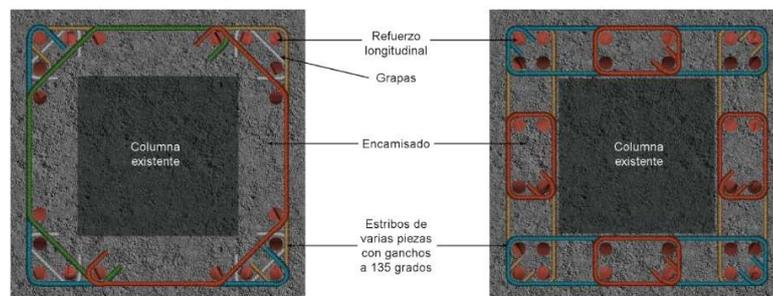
Posibles configuraciones de acero transversal en columnas encamisadas: a) estribos de varias piezas; b) estribos sobrepuestos. Fuente: INIFED (2021d) con base en Terán (2009)
